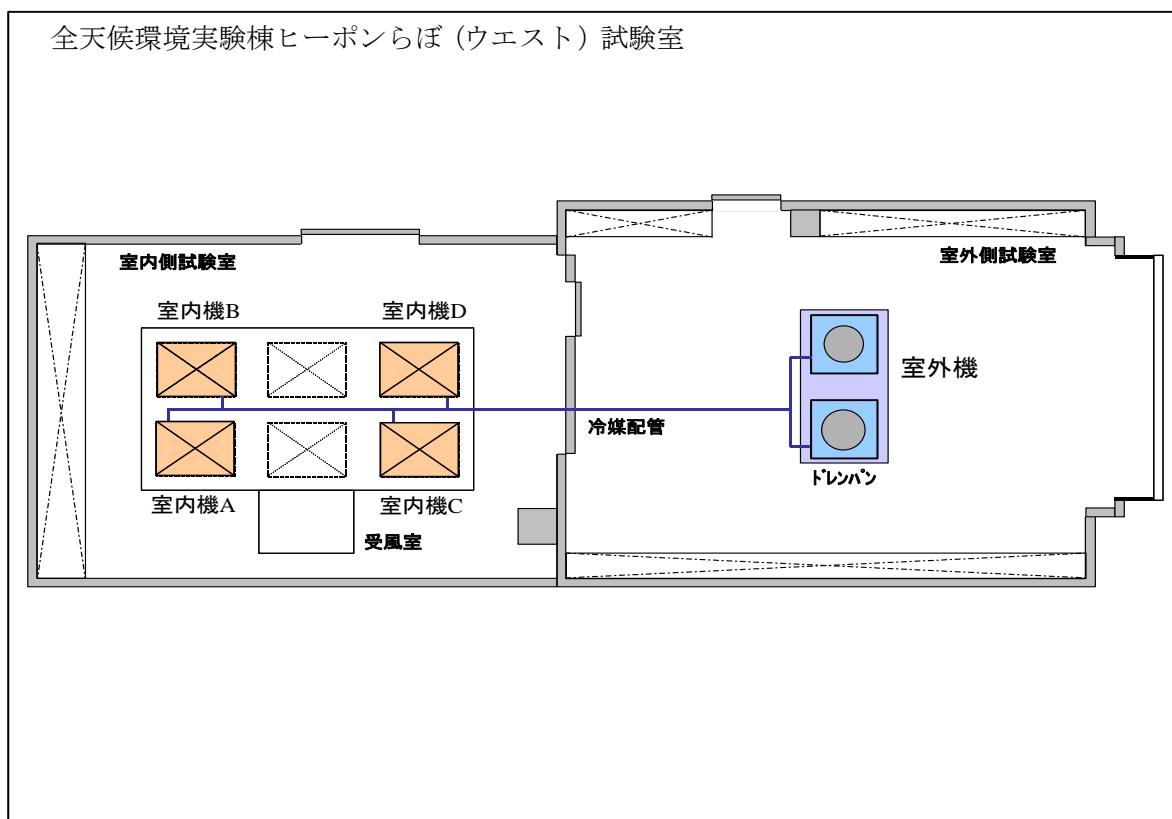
「ヒーポンらぼウエスト」の平面配置図
